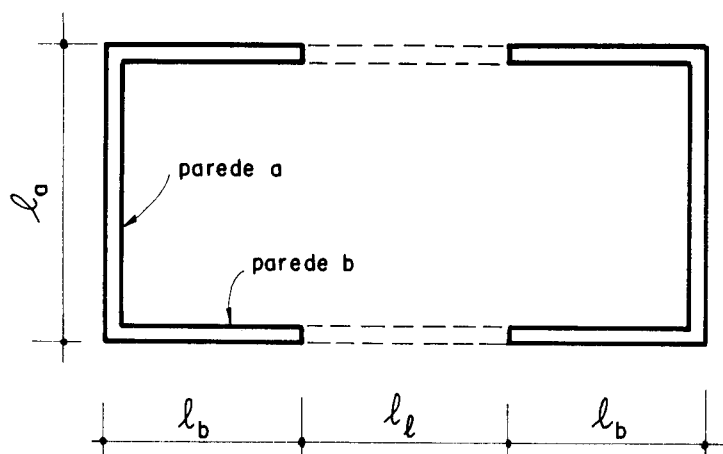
SEÇÃO TRANSVERSAL DO NÚCLEO
